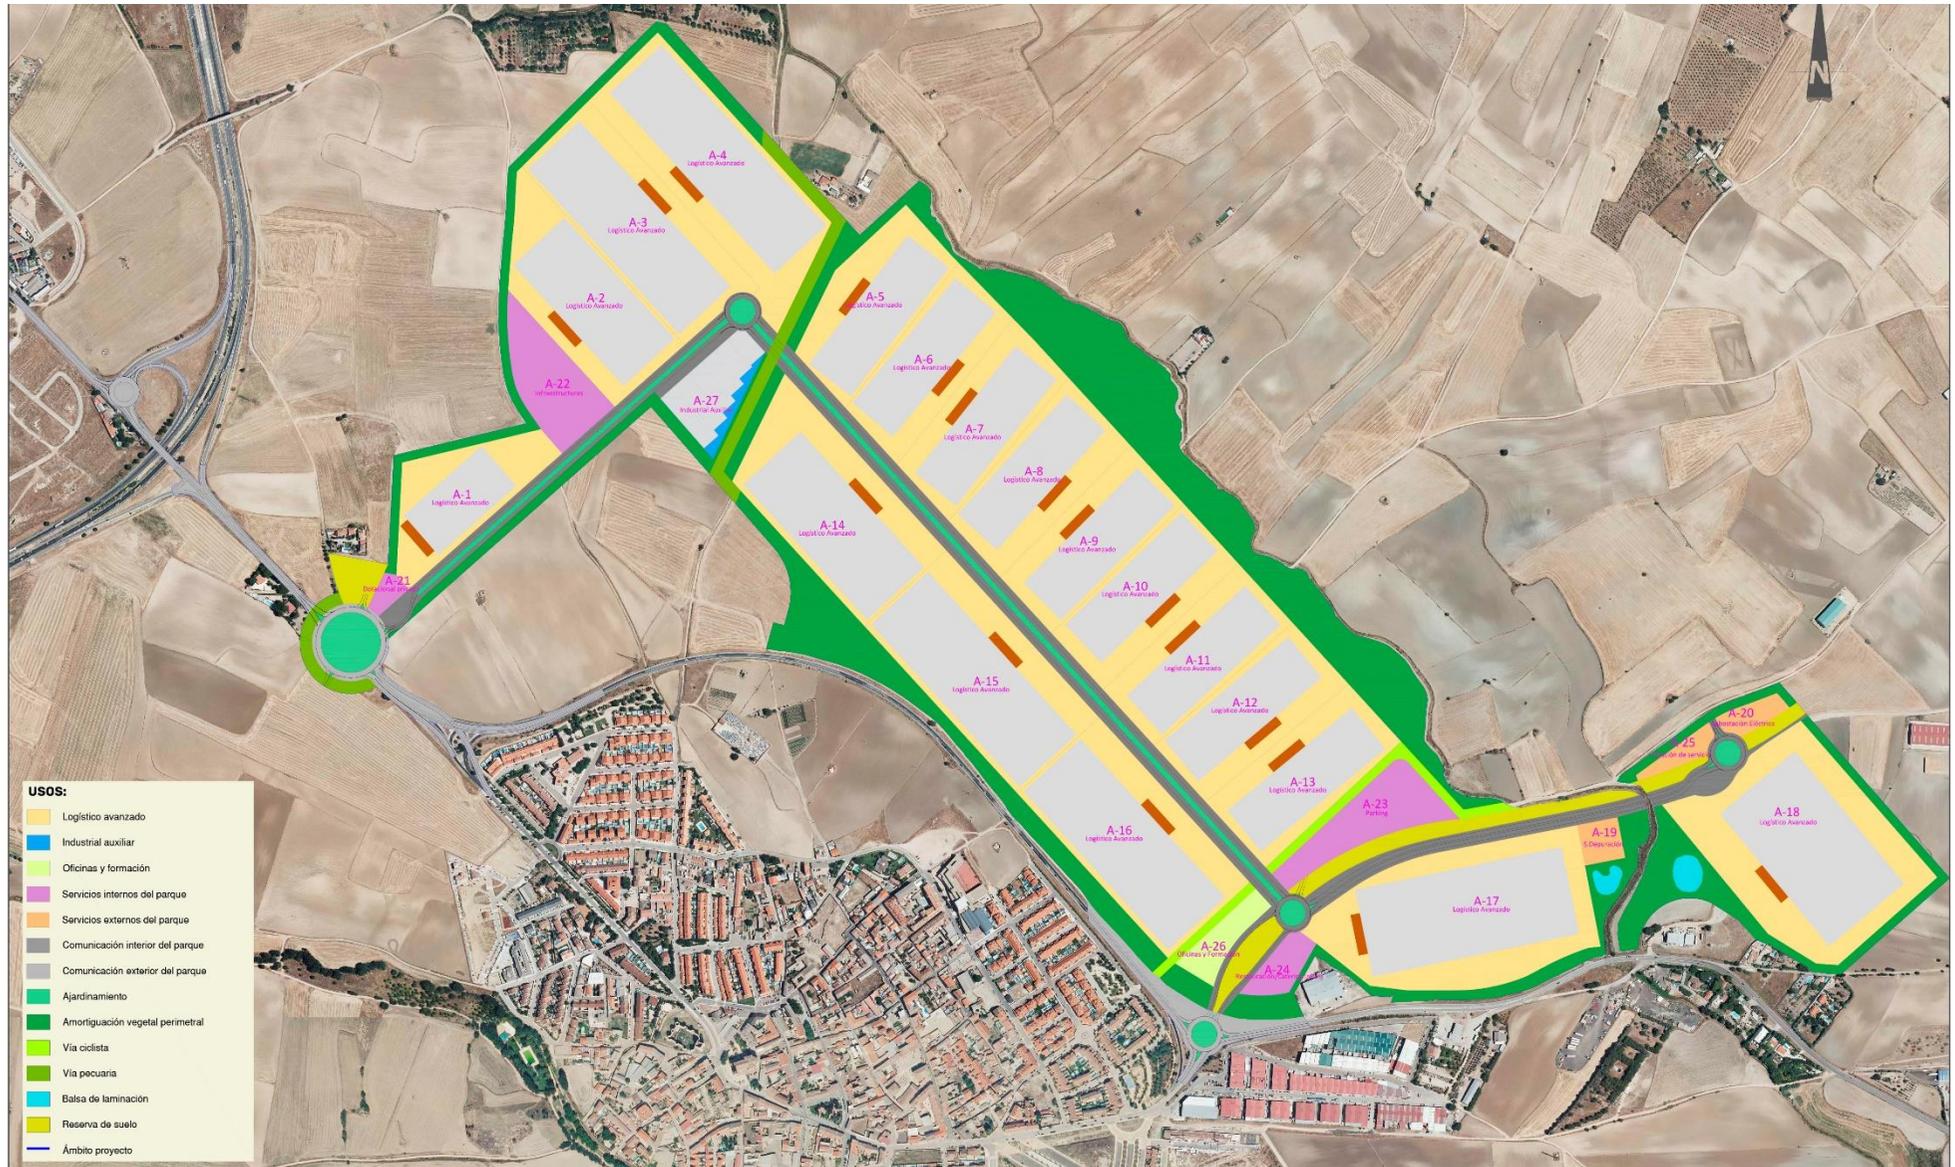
Plano de Proyecto Parque Logístico ERGON A42. Elaboración propia
